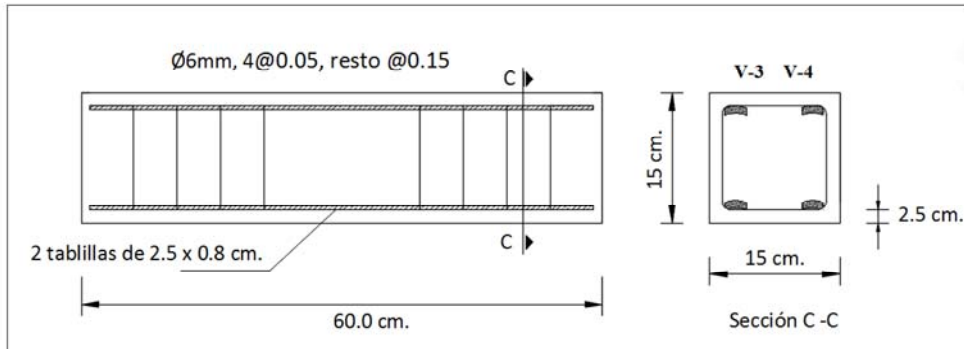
Viga con refuerzo de tablillas de bambú (cuantía 2.3%)
